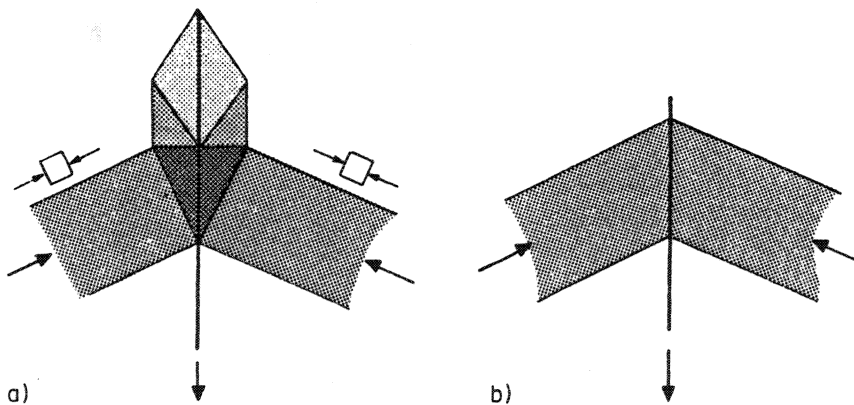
Kraftübertragung Bewehrung - Beton ausserhalb (a) und innerhalb (b) des Knotenbereichs
